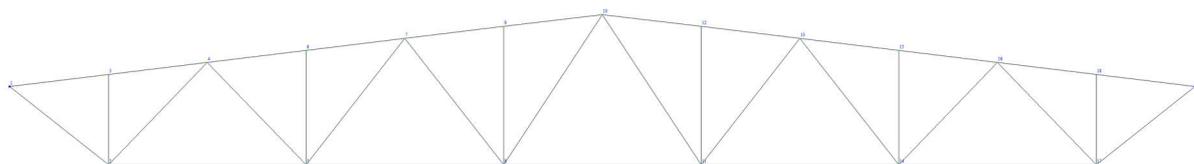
Расчетная схема фермы с нумерацией узлов
